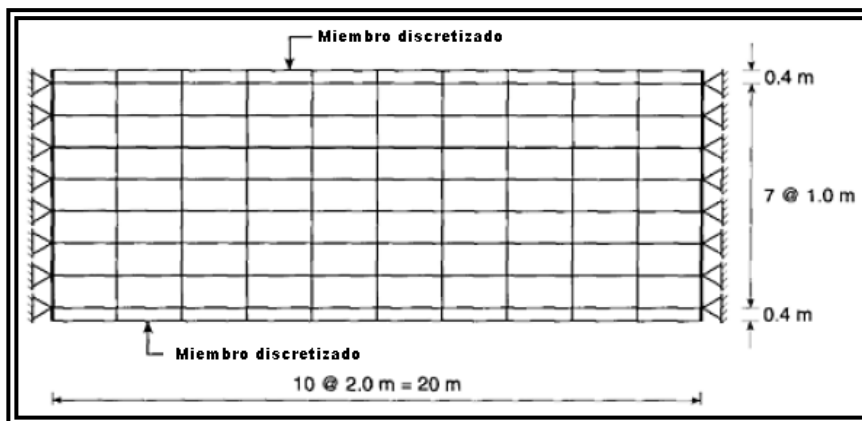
170 Grilla generada para un puente tipo viga-losa.¹⁸⁴
